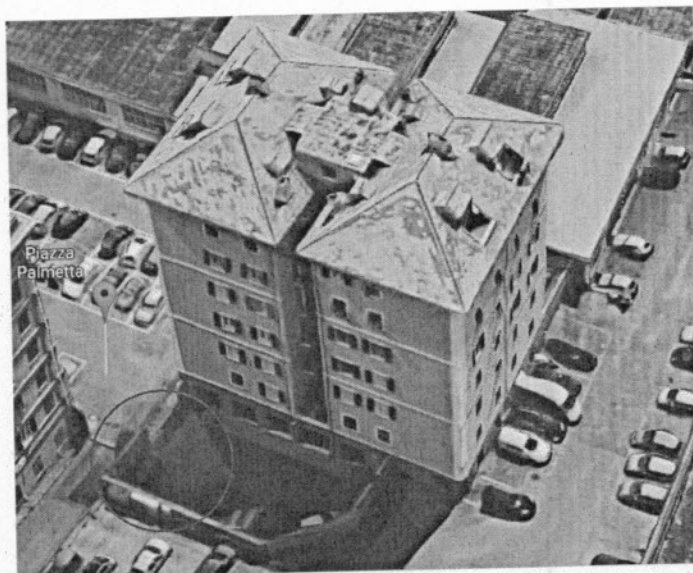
Vista Aerea Prospetto Nord fabbricato e indicazione qualitativa zona posto auto scoperto
